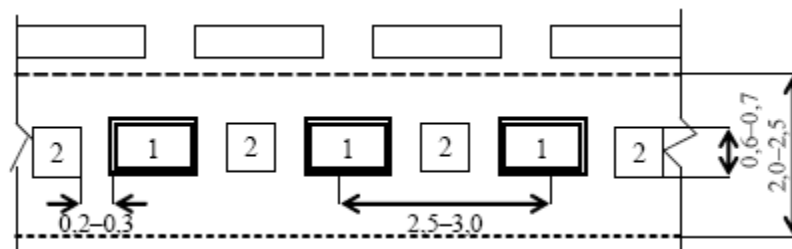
Пример схемы организации рабочего места при возведении наружных стен.
